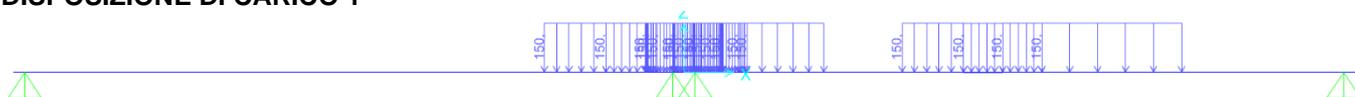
disposizione di carico 1 - SW/2 – pila 2
